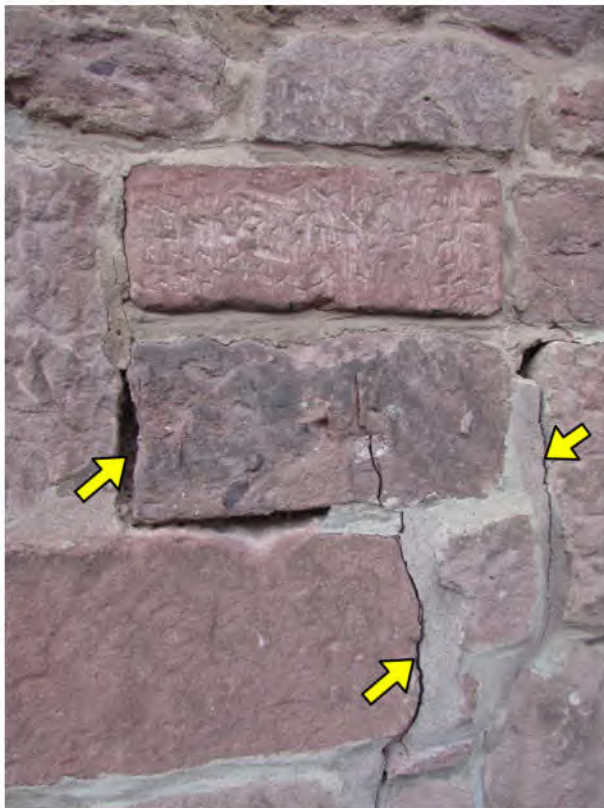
Wohnhaus-Altbau: Risse im Fassadenbereich
